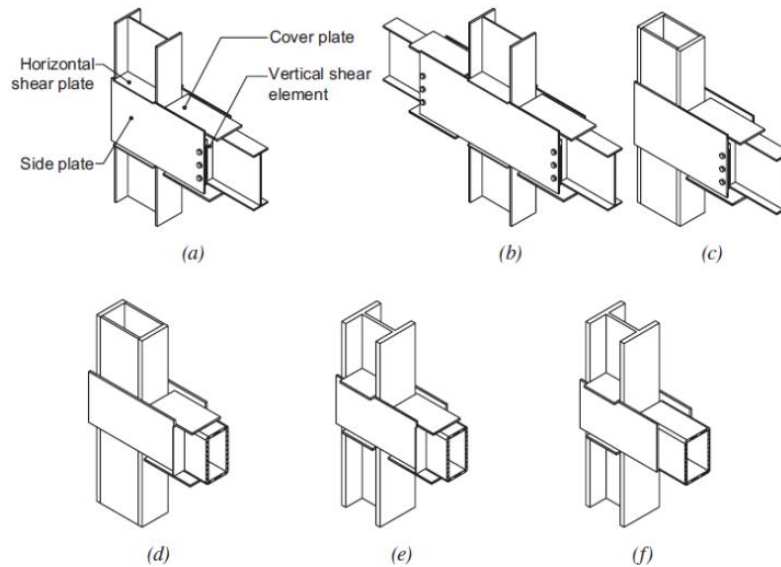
Configuraciones de uniaxial SidePlate ensambladas: (a) construcción de viga y columna de ala ancha a una cara; (b) construcción de viga y columna con ala ancha de dos lados; (c) viga de ala ancha hacia columna construida en cajón; (d) viga HSS sin placas de cubierta hacia columna con alas anchas; (e) Viga HSS con placas de cubierta hacia columna de alas anchas; y (f) Viga HSS con placas de cubierta hacia columna construida en cajón. – Imagen tomada del ANSI/AISC 358-16
